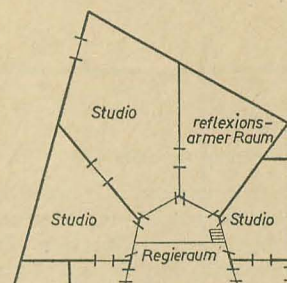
Grundrisse von großen Hörspielstudios, deren Bau nach 1945 beendet wurde
